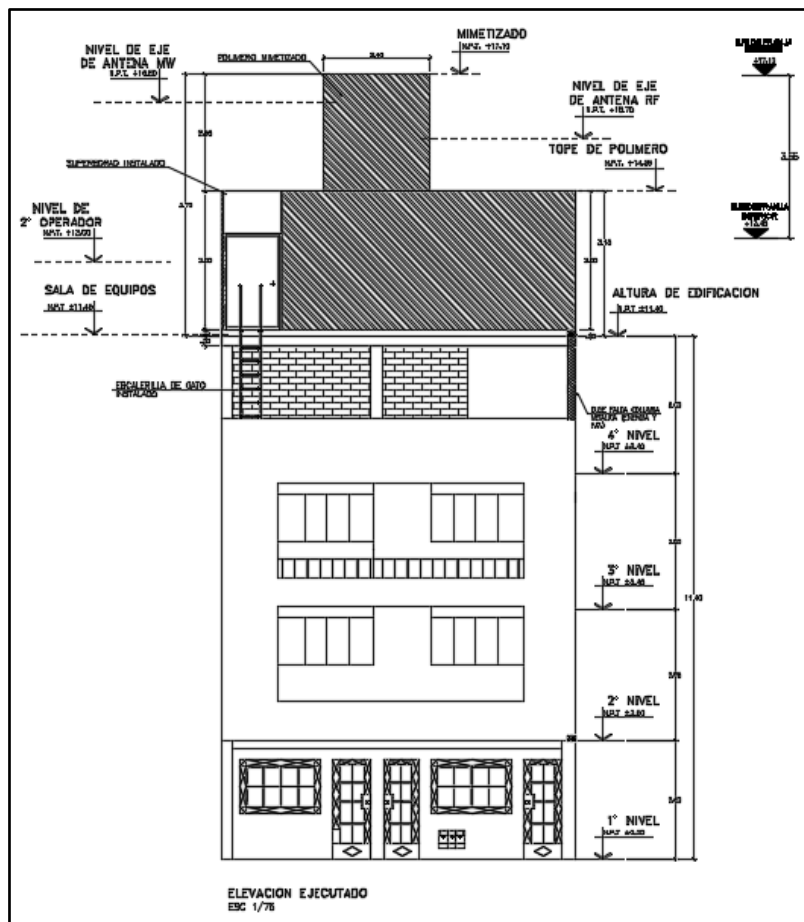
Plano de Elevación Model - Estación Base Celular Tipo Rooftop
